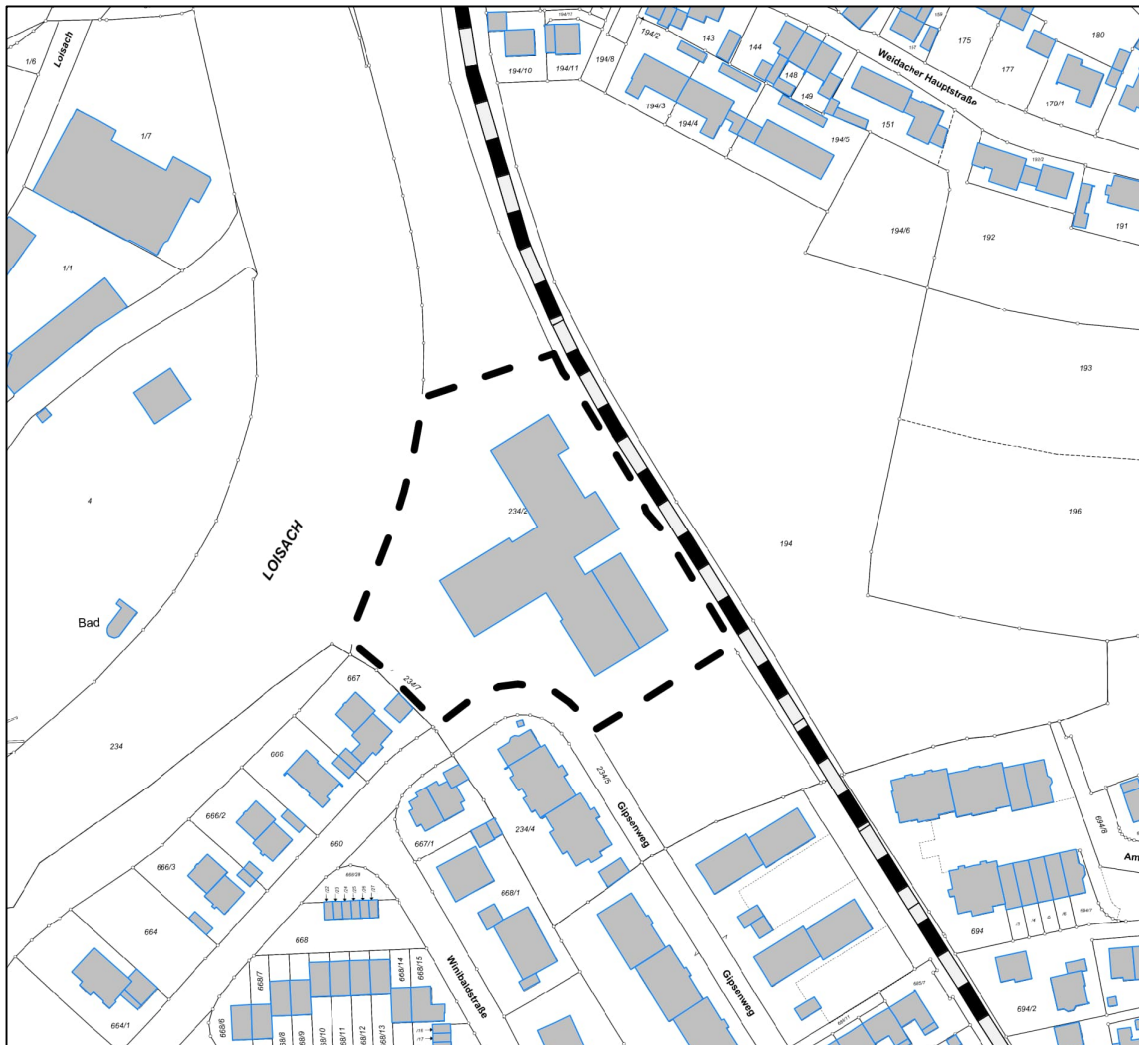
Lageplan mit Darstellung der betrachteten Bahnstrecke
